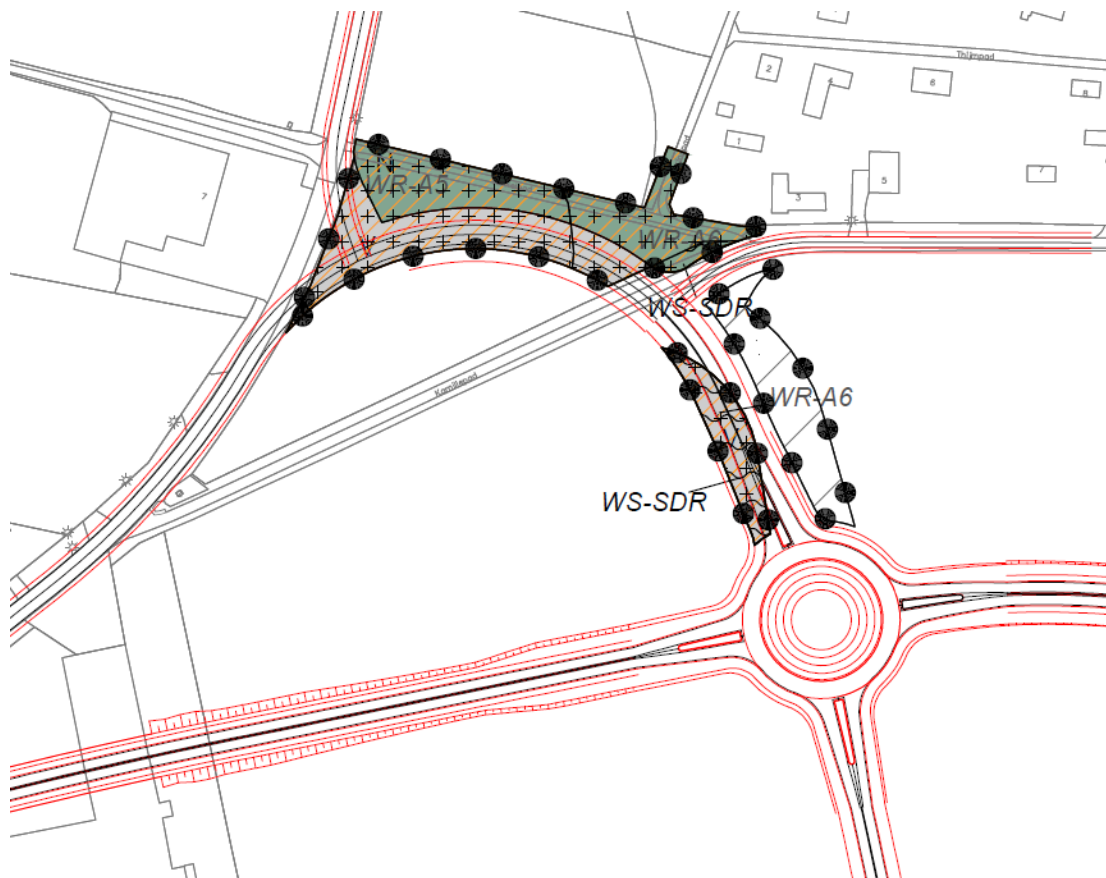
Landschapsplan PIP 15 maart 2017
